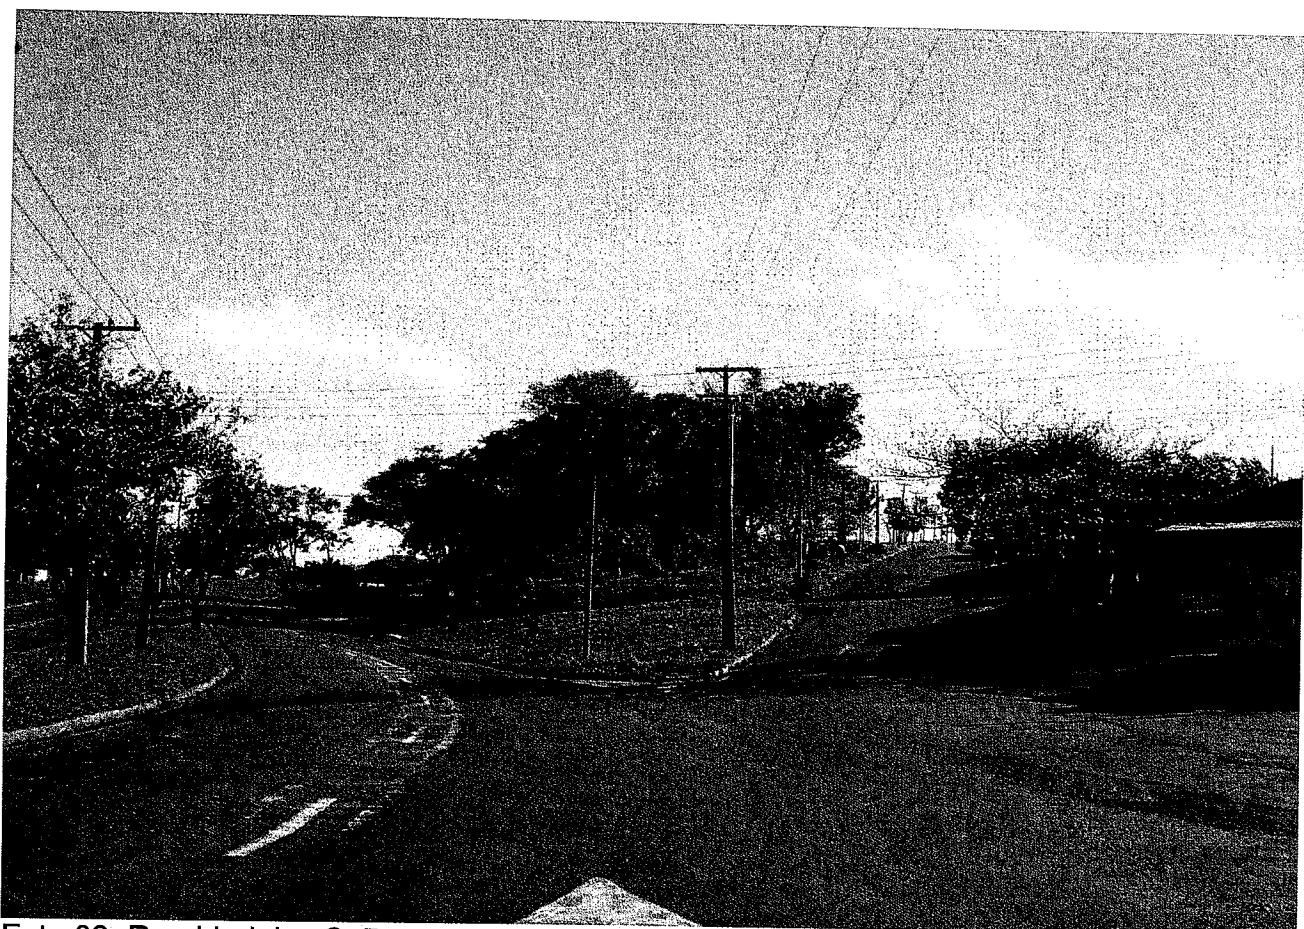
Rua Lindalva S. Basseto x Av. Fco. Gabriel Arruda.
